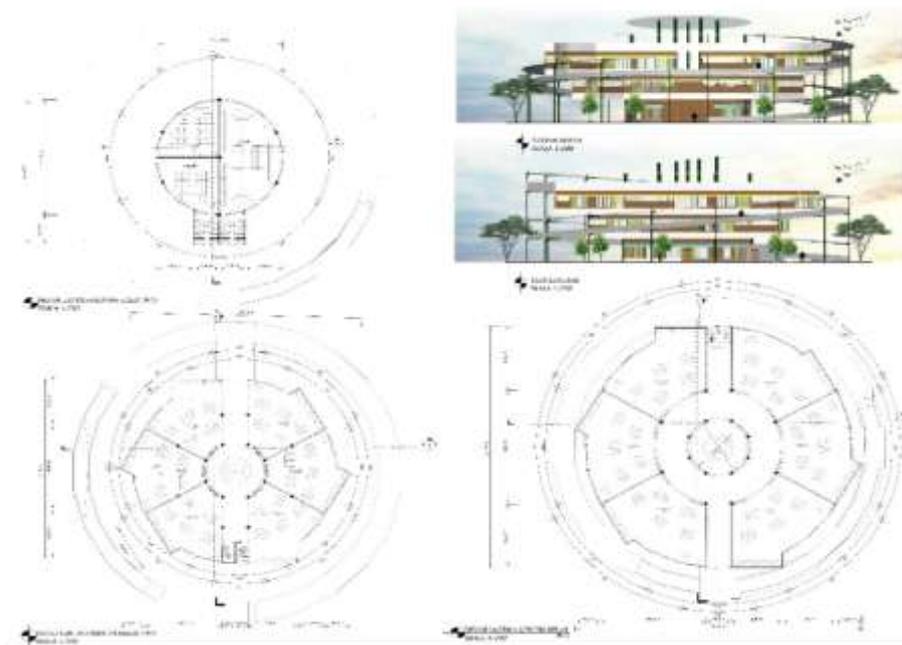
Denah, Tampak dan Potongan Multifunction Hall
